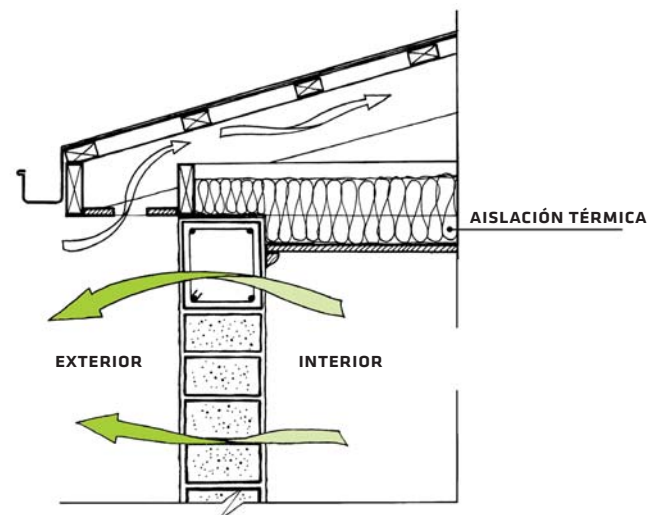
Ejemplos de puentes térmicos en muro de albañilería.
